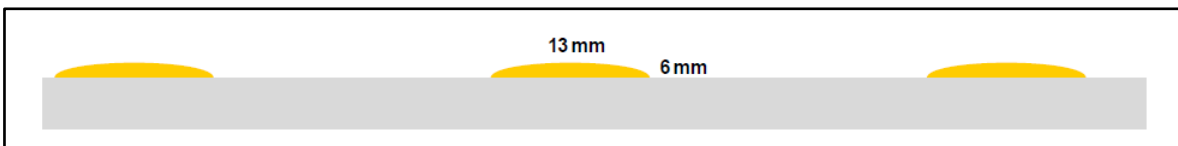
Sección transversal de las franjas que componen las bandas alertadoras. SIECA (2014)
